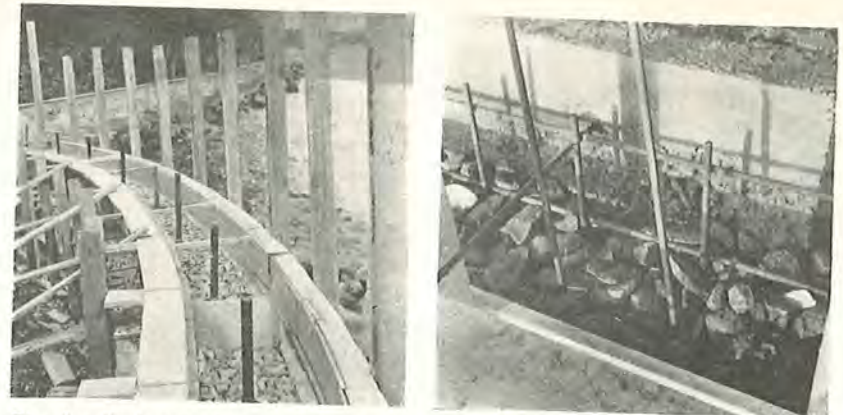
En kappe af uarmeret Colcrete-beton uden om et beskadiget kystsikringsanlæg. Den dårlige beton er borthugget, en kraftig forskalling opsat og sten pakket ved hjælp af vibrering ifyldt denne. De lodrette 2" støberør har en indbyrdes afstand på ca. 75 cm. Fig. 84. Tilsvarende kappe af armeret Colcrete-beton. Det relativt storkornede stenmateriale indvirker på udformningen af armeringen i en sådan konstruktionsdel, idet en sådan armering må udføres med forholdsvis store maskevidder og afstande fra overfladerne, således at de relativt store sten kan finde plads.
